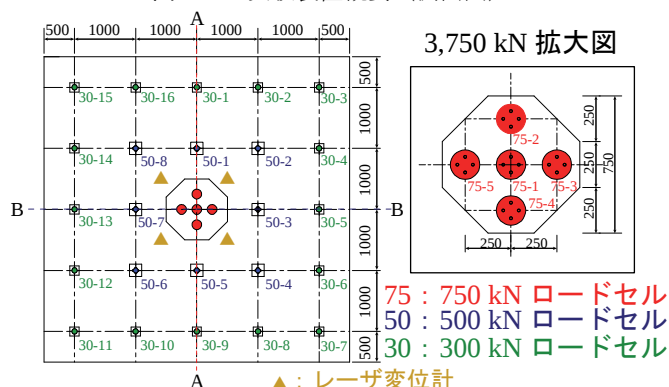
伝達衝撃力計測用ロードセル配置図(平面図)
